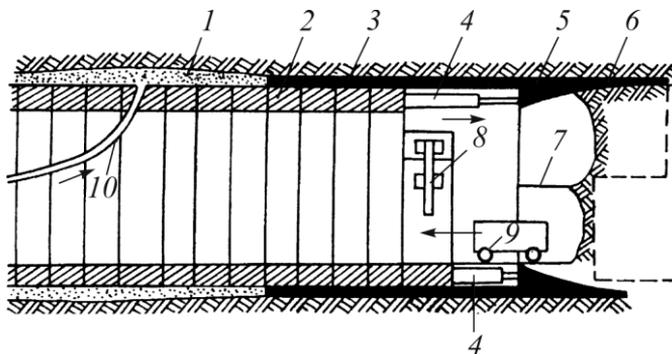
Схема проходки туннеля с помощью щита: 1 – полость, заполненная бетонной смесью; 2 – обделка туннеля из тубингов; 3 – обойма щита; 4 – домкраты; 5 – режущий
